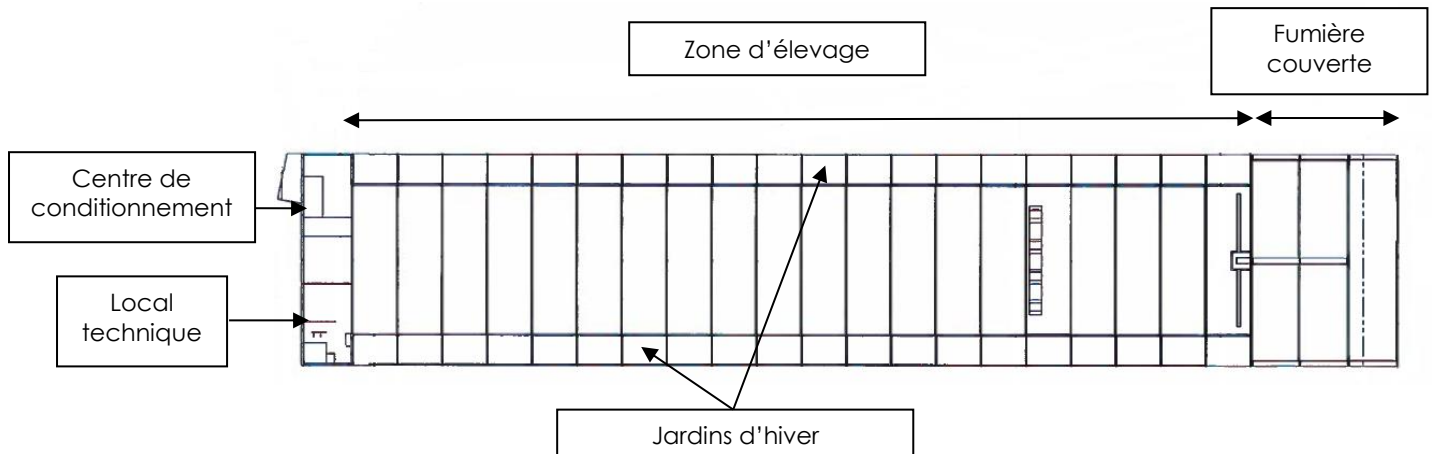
Plan du futur bâtiment V1 (Source : SL2E08)
